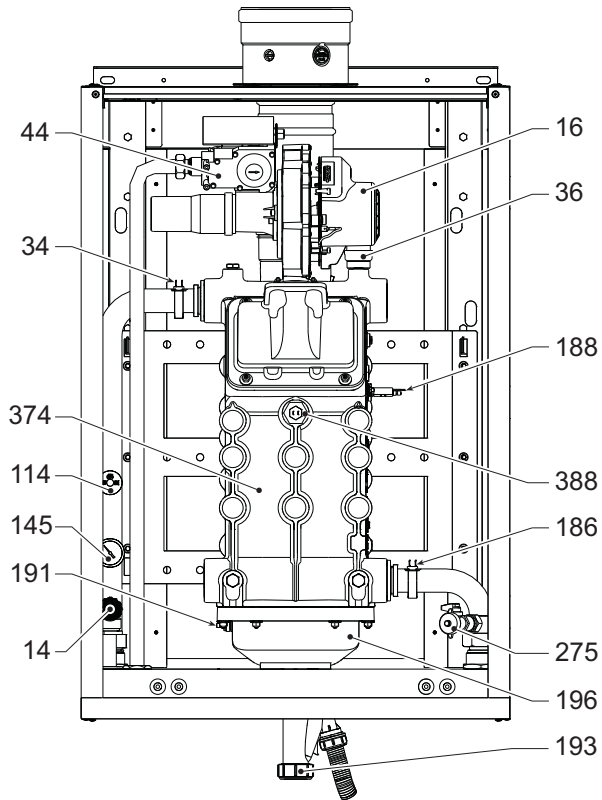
Vue générale mod. TORO W 60 et TORO W 80
